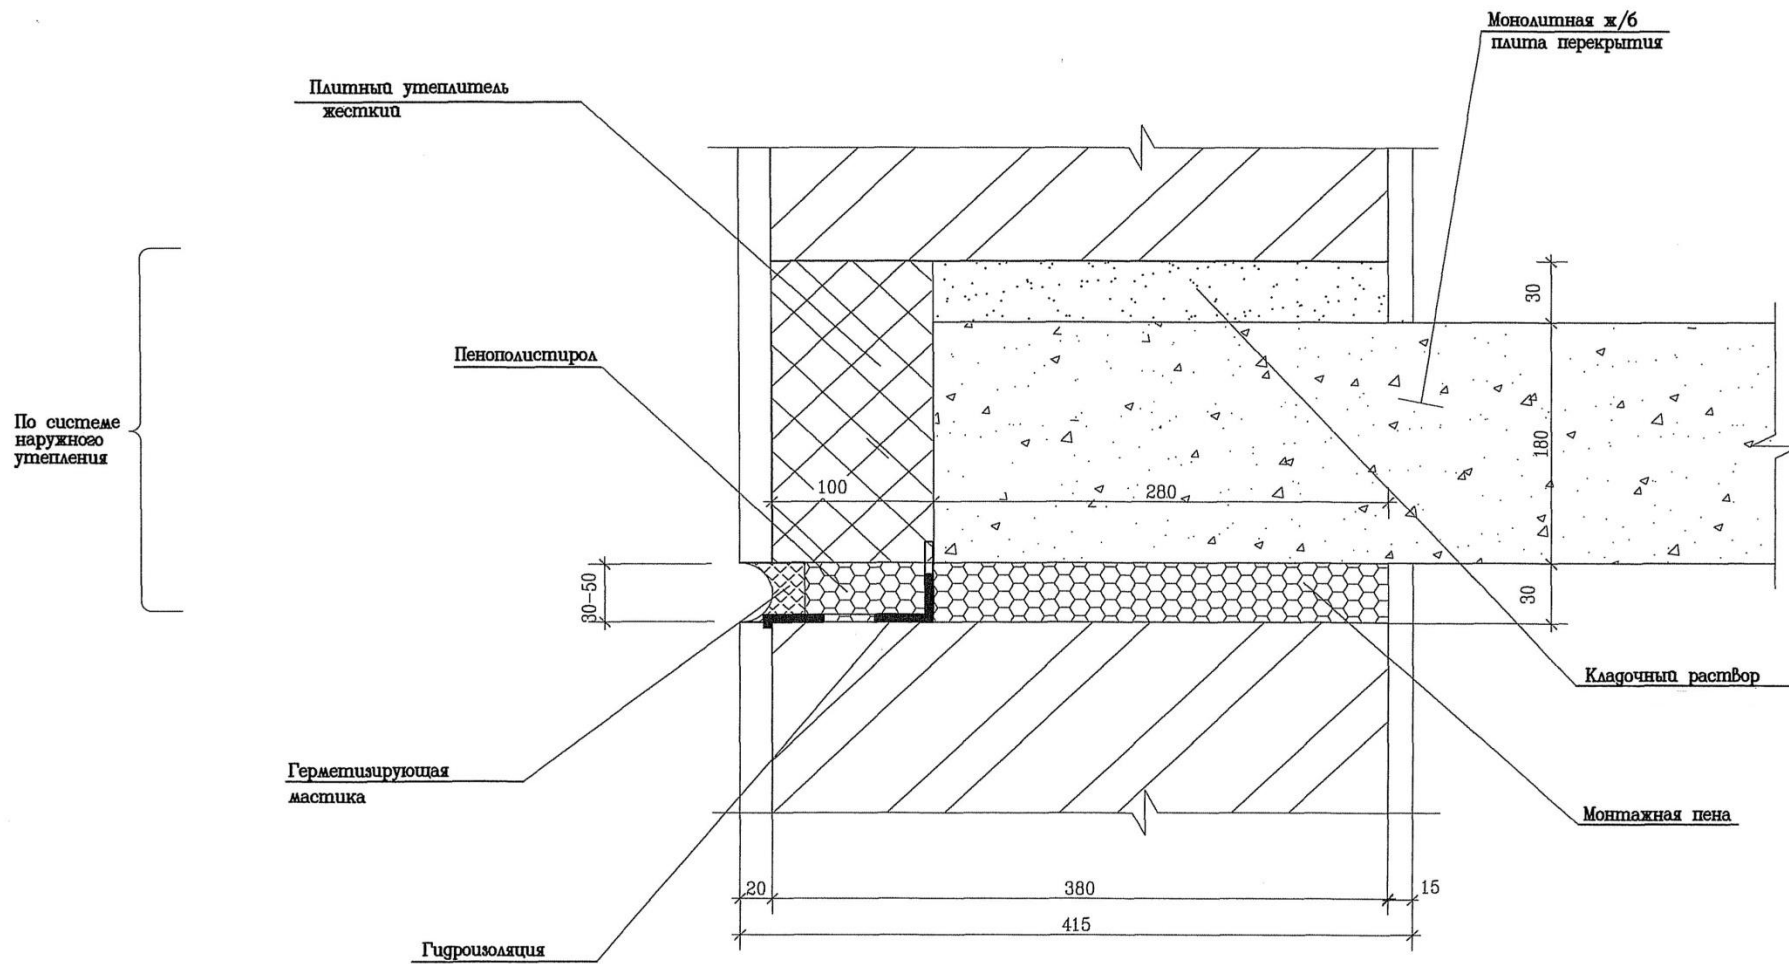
Узел 1 (стены с плоской плитой перекрытия)
